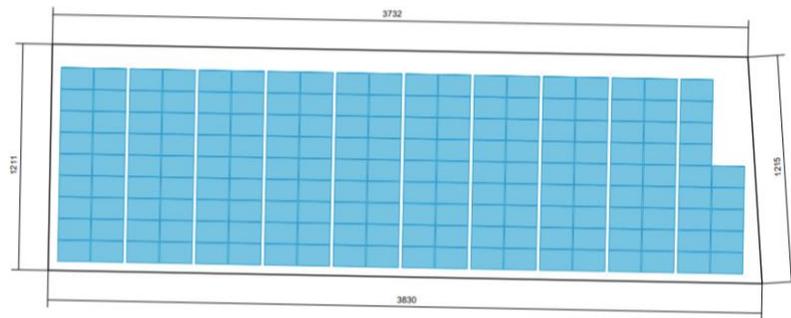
Kirchstrasse 6, Belegungsplan, Dachfläche 2
